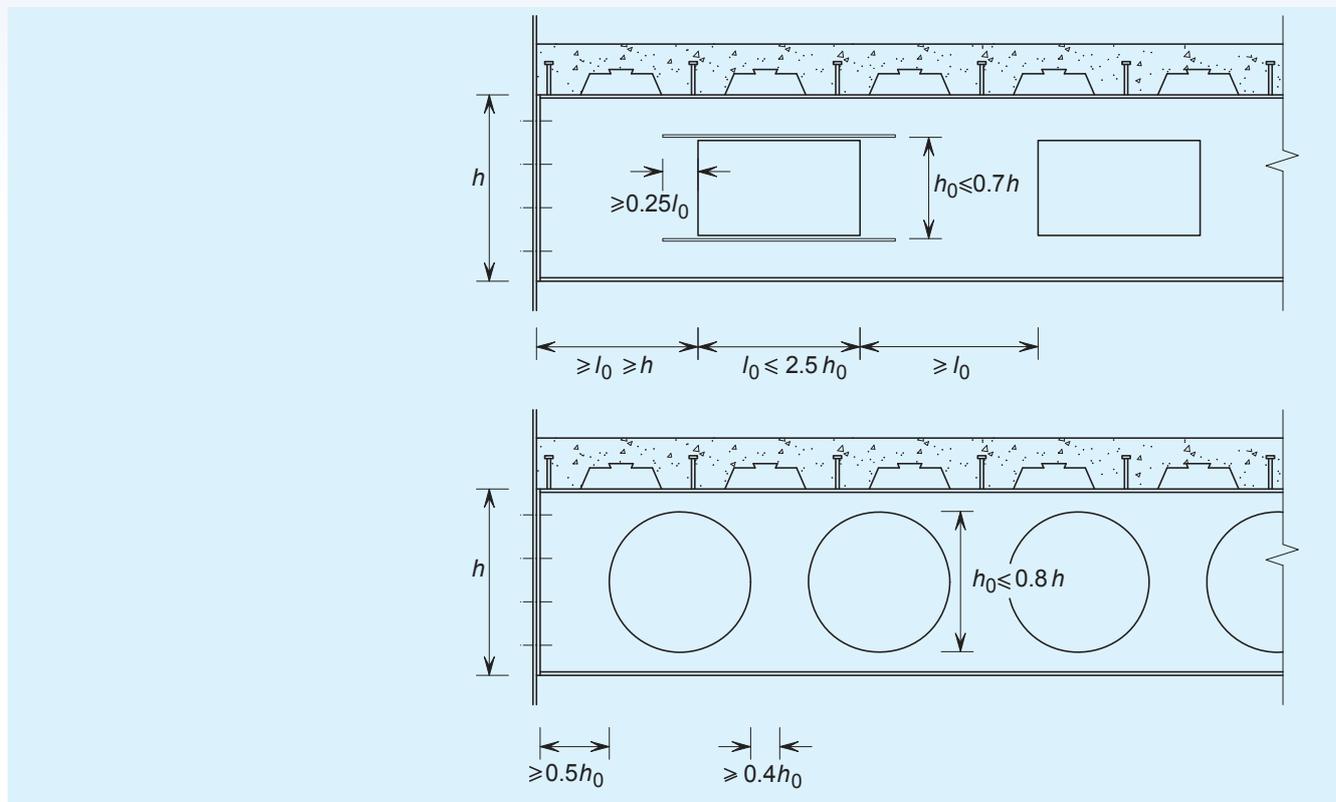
Требования по размерам и расположению круглых и прямоугольных отверстий в стенке перфорированной балки
